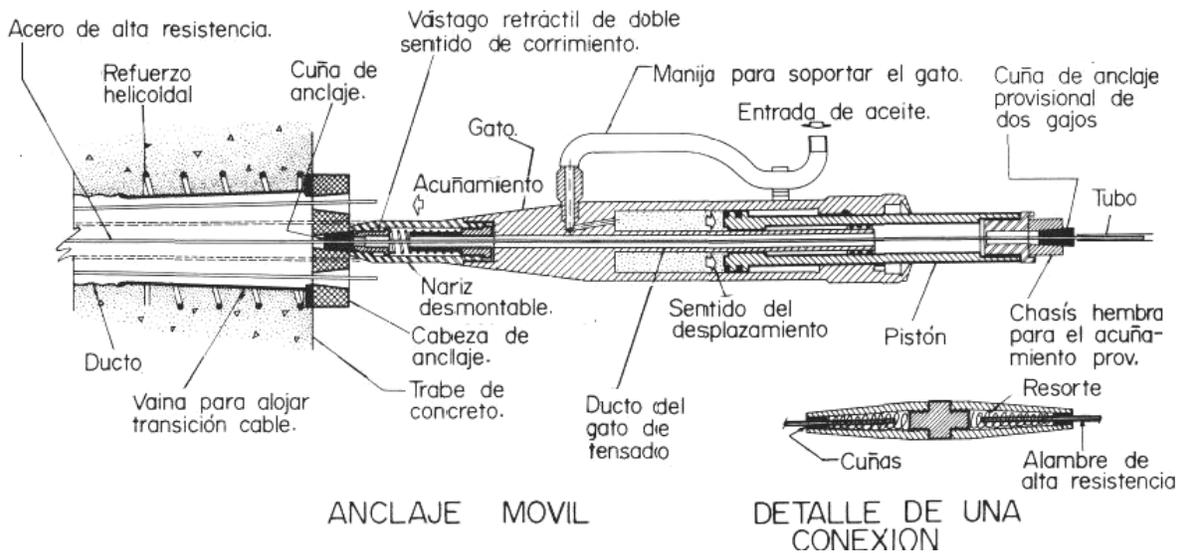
Aplicación del presfuerzo según el sistema Gifford-Udall.
